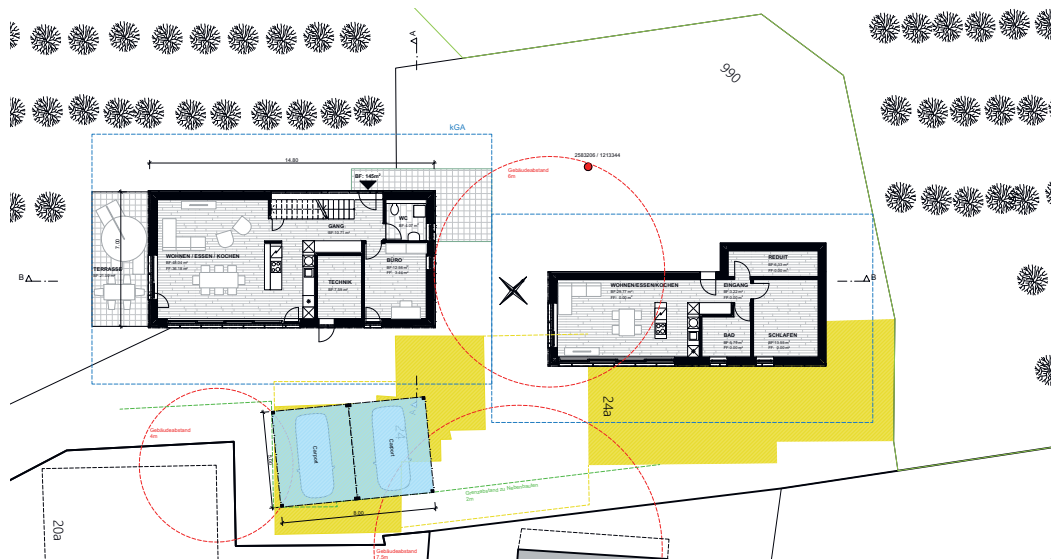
Projekt Grundriss Erdgeschoss (Quelle: Wüthrich Architekten AG)
